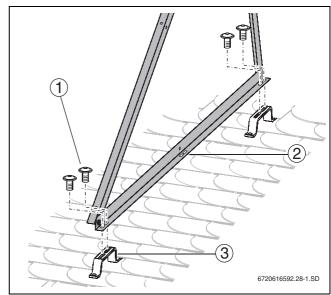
Fijación del tejado con ganchos especiales (aquí: en tejado con pizarra o chillas)
